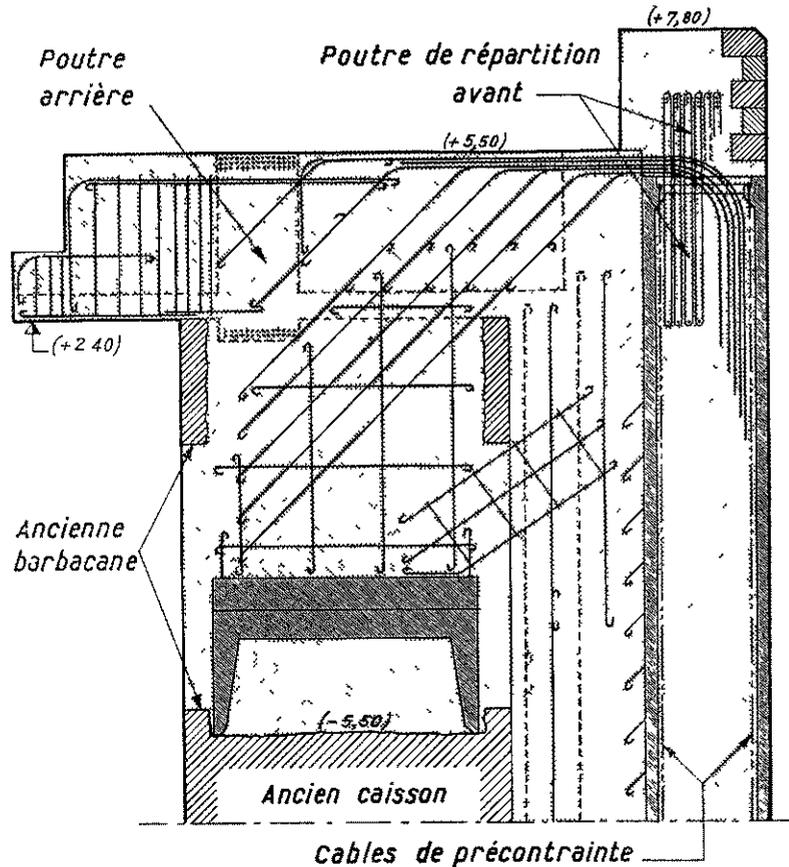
Coupe dans un caisson pile et un contrefort.
